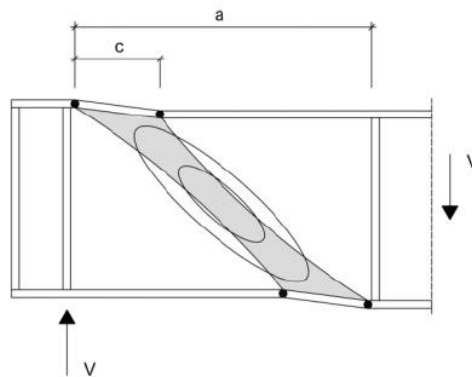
Modelo de rotura de uma viga de secção soldada de alma cheia submetida a um campo de tensões de corte puro [23]
